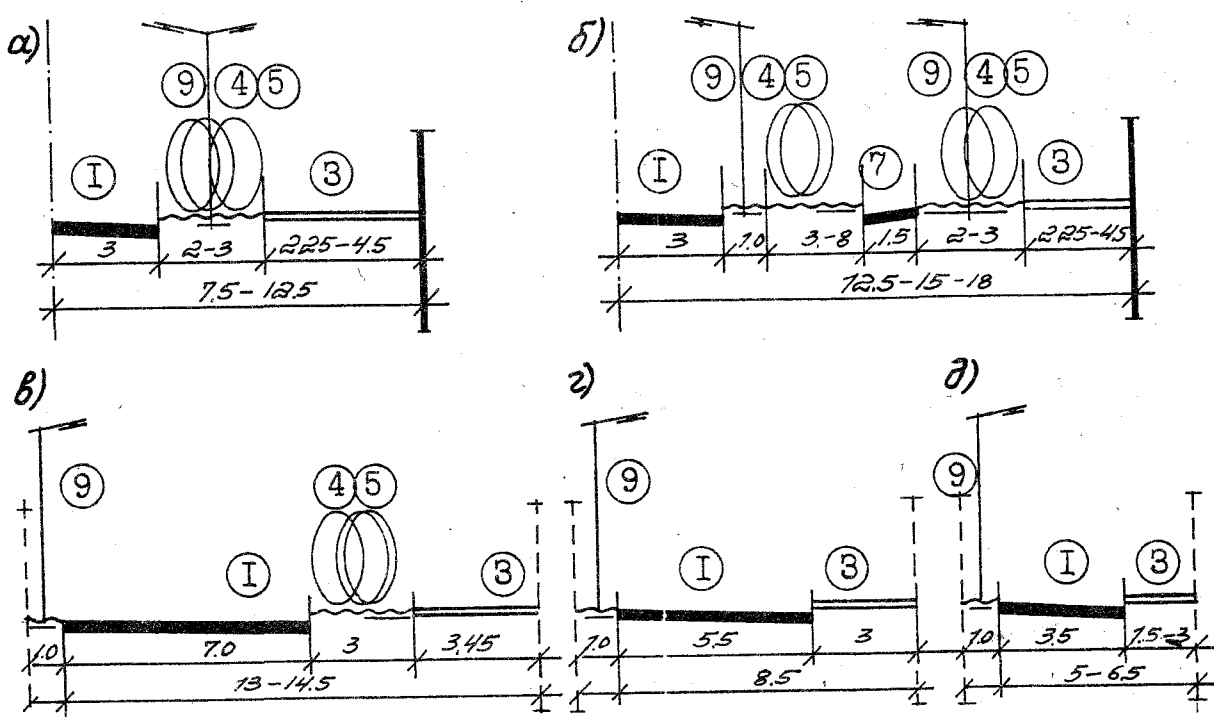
Поперечные профили: а - жилых улиц; б - дорог местного значения; в - главных проездов; г - основных проездов; д - подъездов к зданиям
